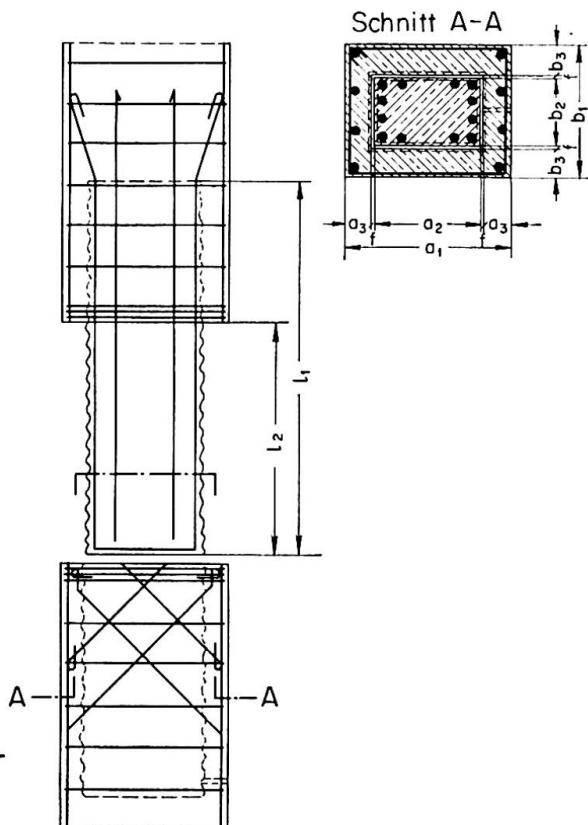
Abmessungen und Bewehrungsanordnung für den Stahlbetonzapfenstoß.
